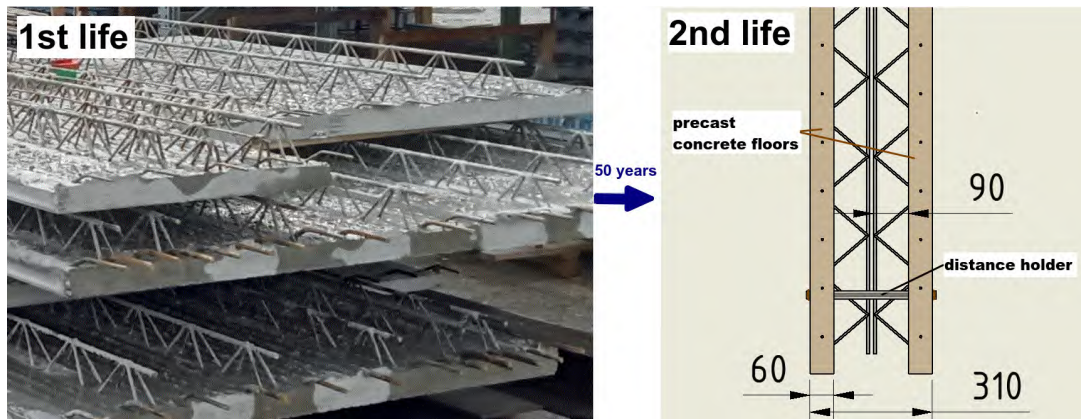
Links: Gewöhnliche, vorgefertigte Elementdecke/Filigrandecke als Druckgurt in einer HBV-Decke. Rechts: Wiederverwendung der HBV-Fertigbetondecke als Elementwand/Betonwand im zweiten Leben. Die beiden Teilwände bestehen aus ehemaligen Filigrandecken und wurden einer rückbaubaren Holz-Beton-Verbunddecke entnommen. Sie können - ähnlich wie bei System-Rahmenschaltafeln - mit Elementverbindern und Richtschloß justiert werden (z.B. von <https://www.peri.de>, zuletzt aufgerufen Mai 2025), und danach mit Ortbeton ausgegossen werden.
